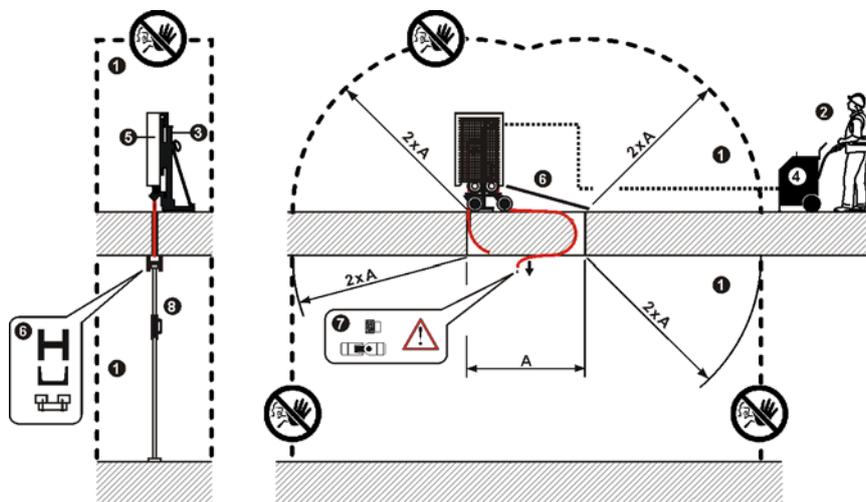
Zona de perigo e de trabalho no corte no pavimento
